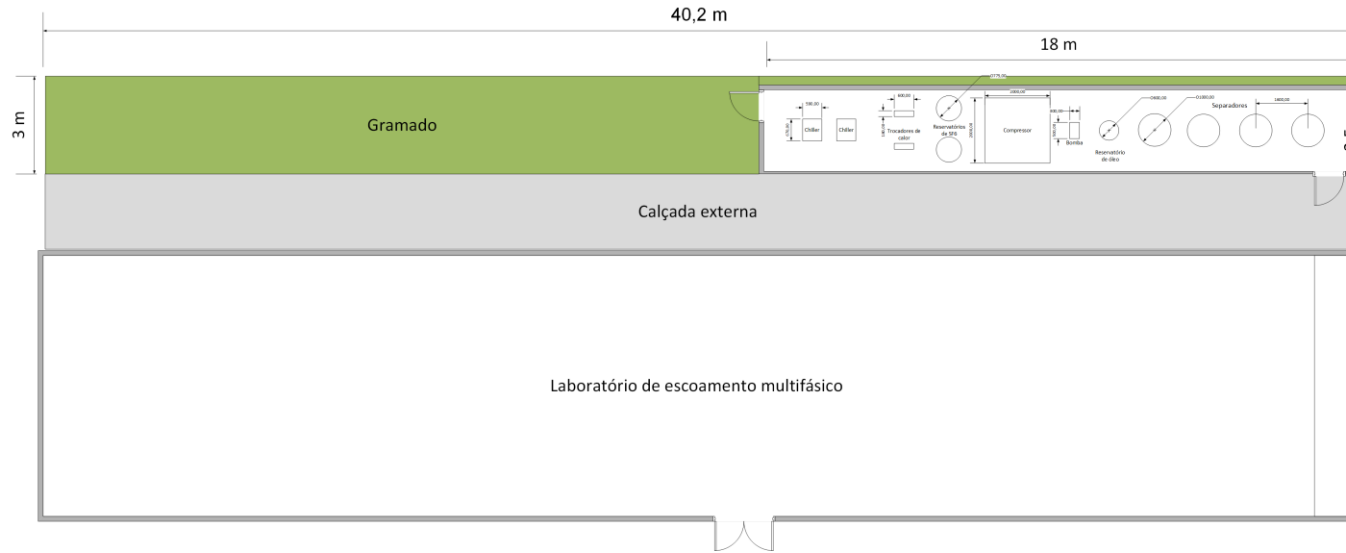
Vista geral do local de instalação da casa de máquinas
